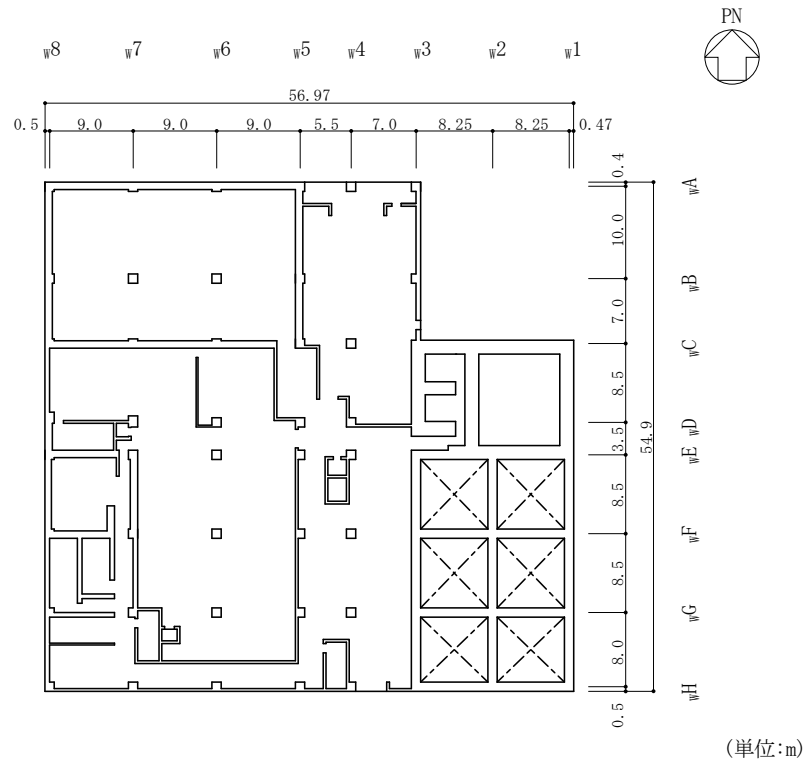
(7) 廃棄物処理建物の概略平面図 (EL 32.0m)
